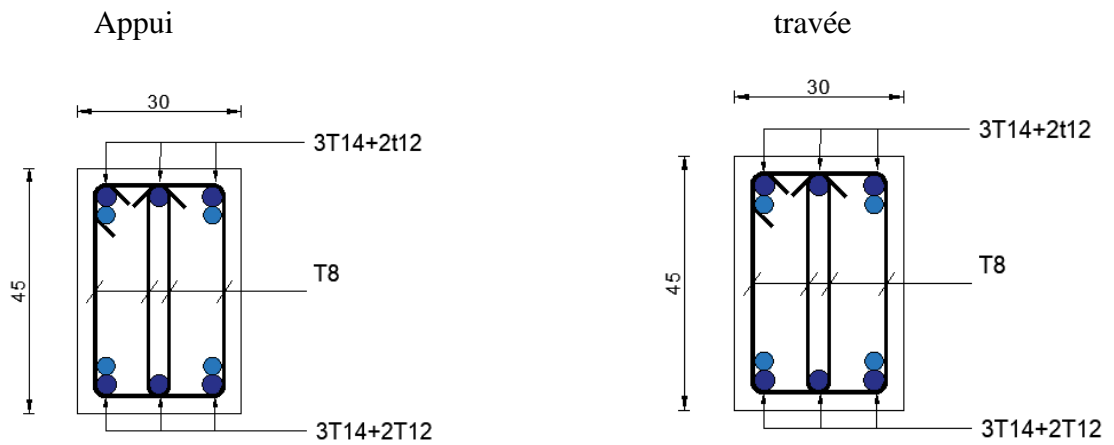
schéma de ferrailages des poutres principales 2 (9^{ème} étage)
